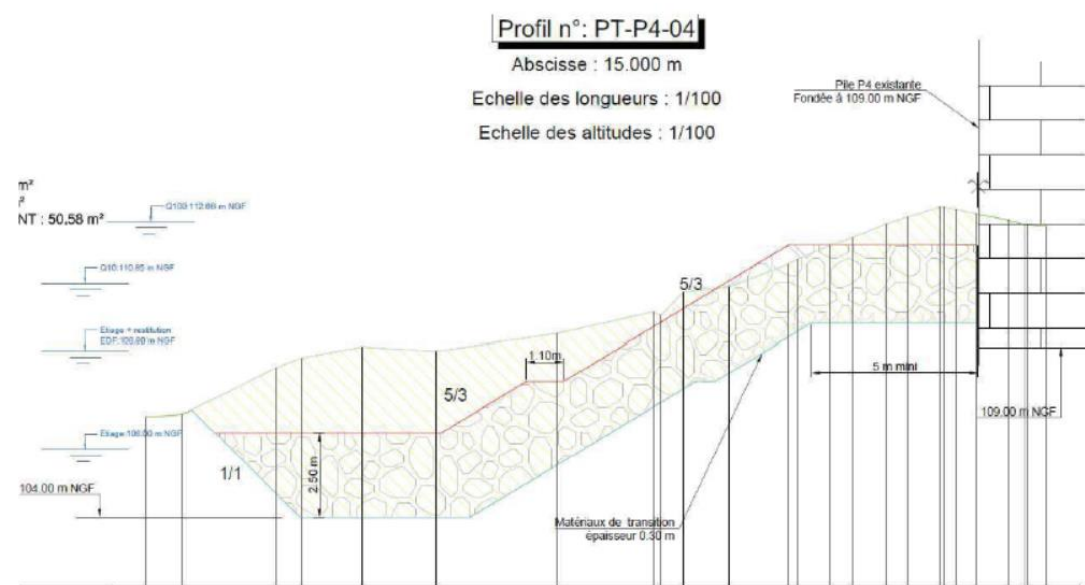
Coupe-type des protections – pile P4 (setec Hydratec)
